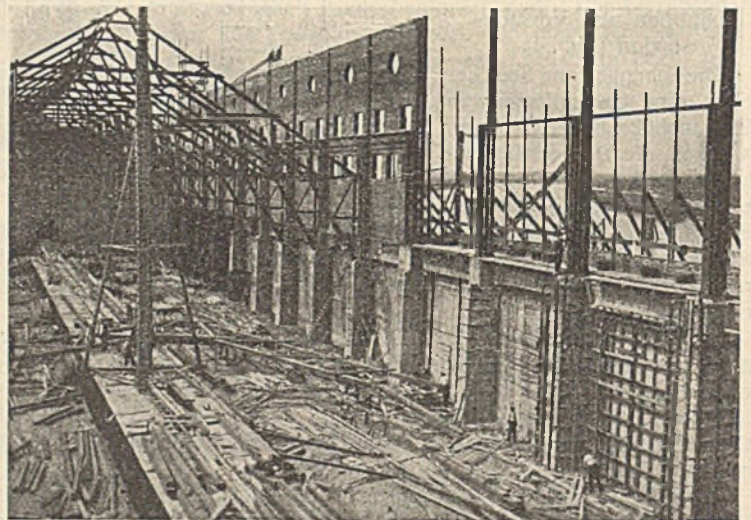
Wasserseitige Wand und Mittelschuppen.
